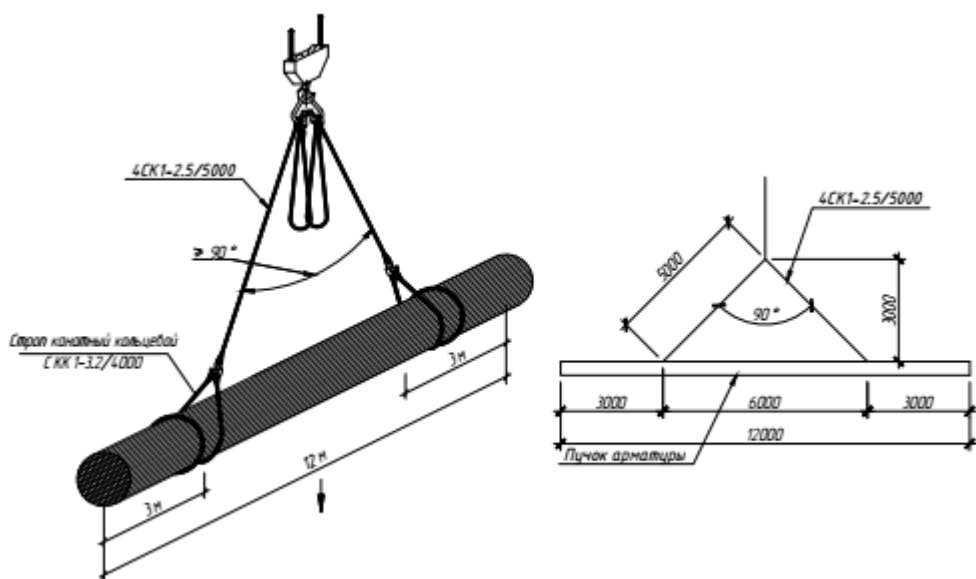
Схема строповки стержневой арматуры в пучках
